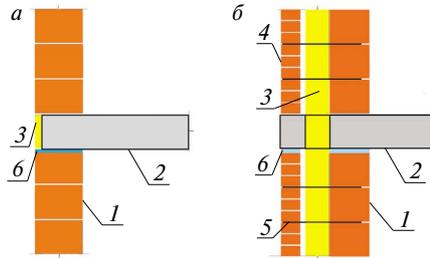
Наружная стена: а – однослойная с закрытым торцом плиты перекрытия; б – трехслойная с открытым торцом плиты перекрытия; 1 – кладка из крупноформатных керамических камней; 2 – железобетонная плита перекрытия; 3 – утеплитель; 4 – кладка лицевого слоя; 5 – гибкая связь; 6 – горизонтальный деформационный шов
